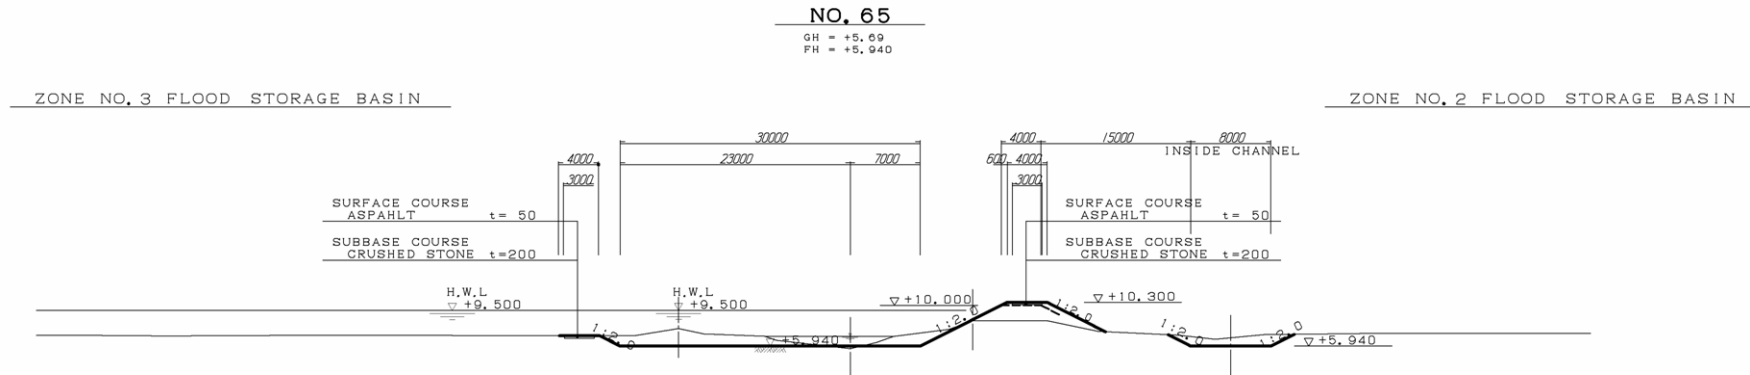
⑥～⑦区間の放水路路標準断面図
